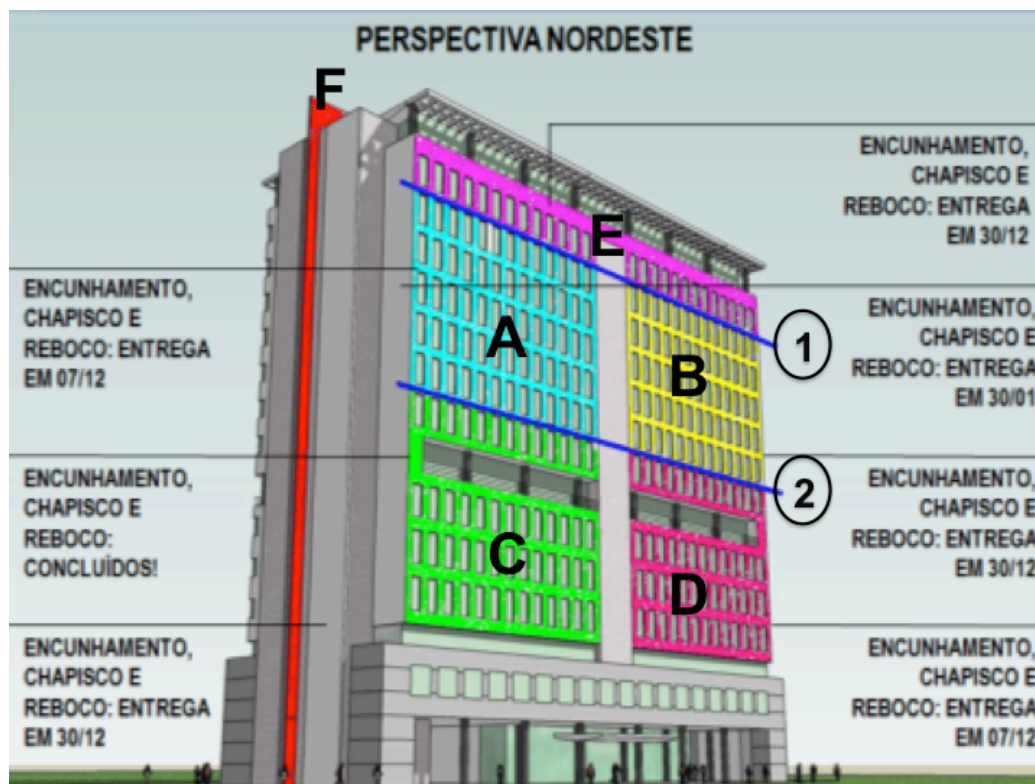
Plano estratégico para entrega dos lotes de fachada
